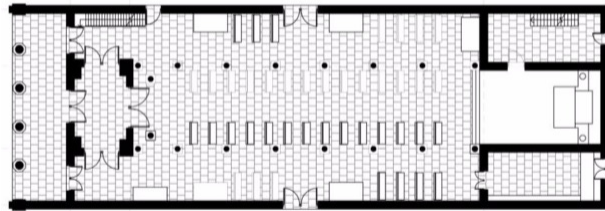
Representación gráfica de una planimetría idealizada en planta.
